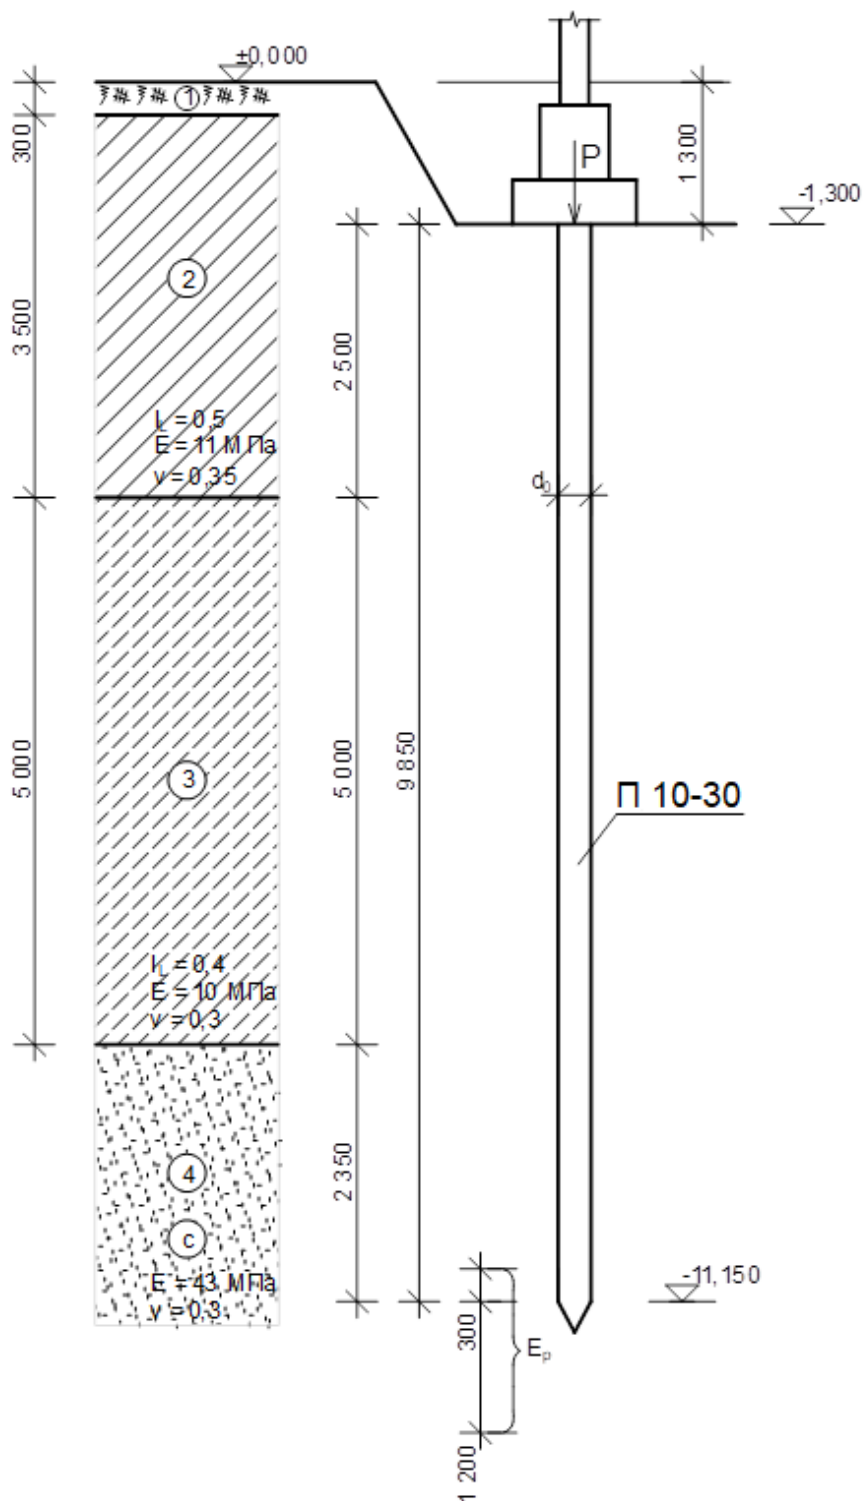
Розрахункова схема і розміщення в ґрунті пальового фундаменту
